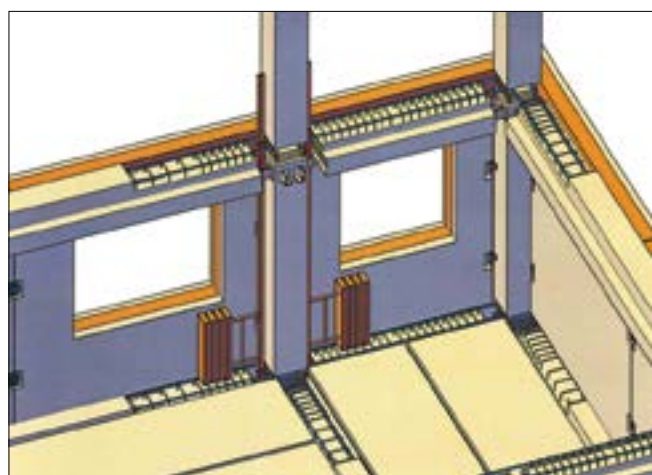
Монтажный вид здания с узлами сопряжения элементов несущего каркаса (в разрезе)
